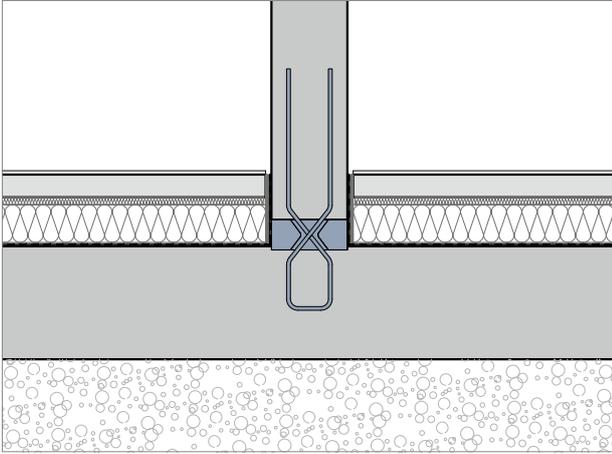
Schöck Sconnex® type W mur intérieur sur radier
